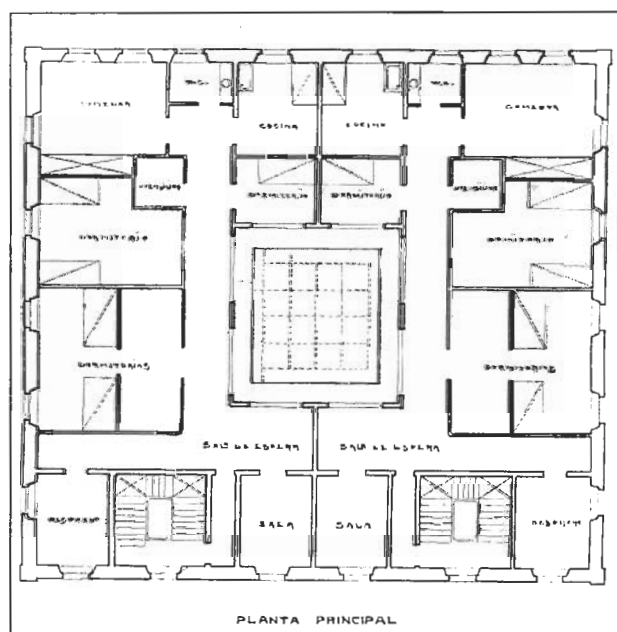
Planta principal del proyecto de escuela para San Pedro.
